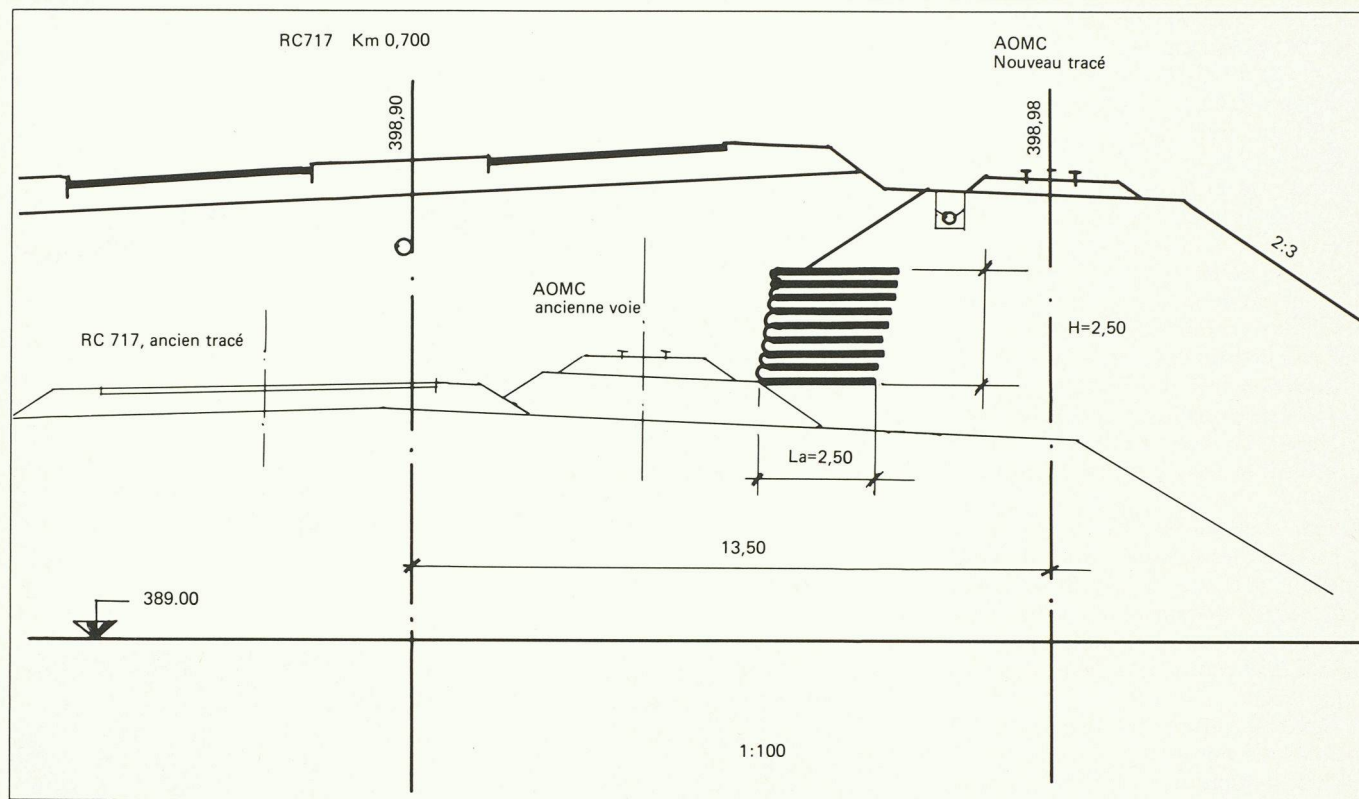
N9 - Saint-Triphon - Profil en travers Km 0,7 - Mur renforcé par géotextiles.
